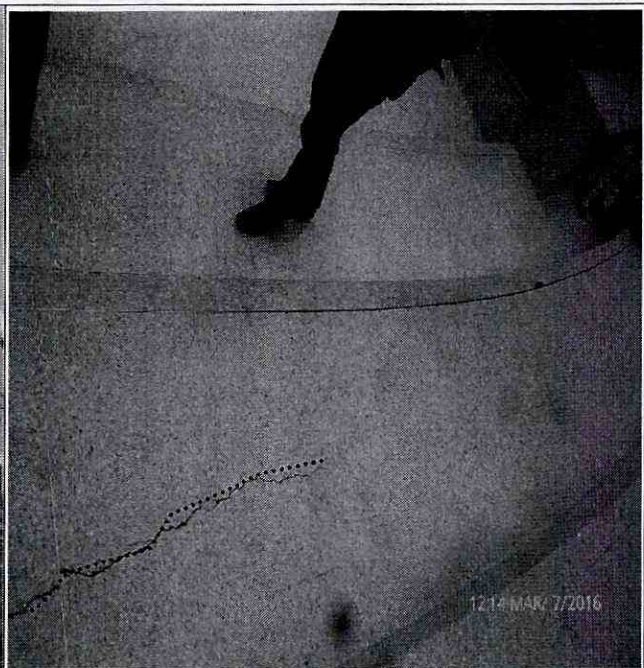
Fisuras de tendencia longitudinal de aberturas entre 2mm-3mm y longitudes de 0.5m – 1m, en el sector del primer nivel (plazoleta central de eventos)
